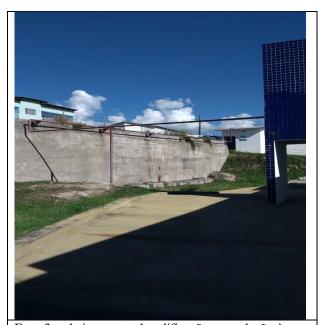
rebaixamento da edificação em relação à rua; ao fundo, muro de arrimo, foto tirada em 08/05/2017.
